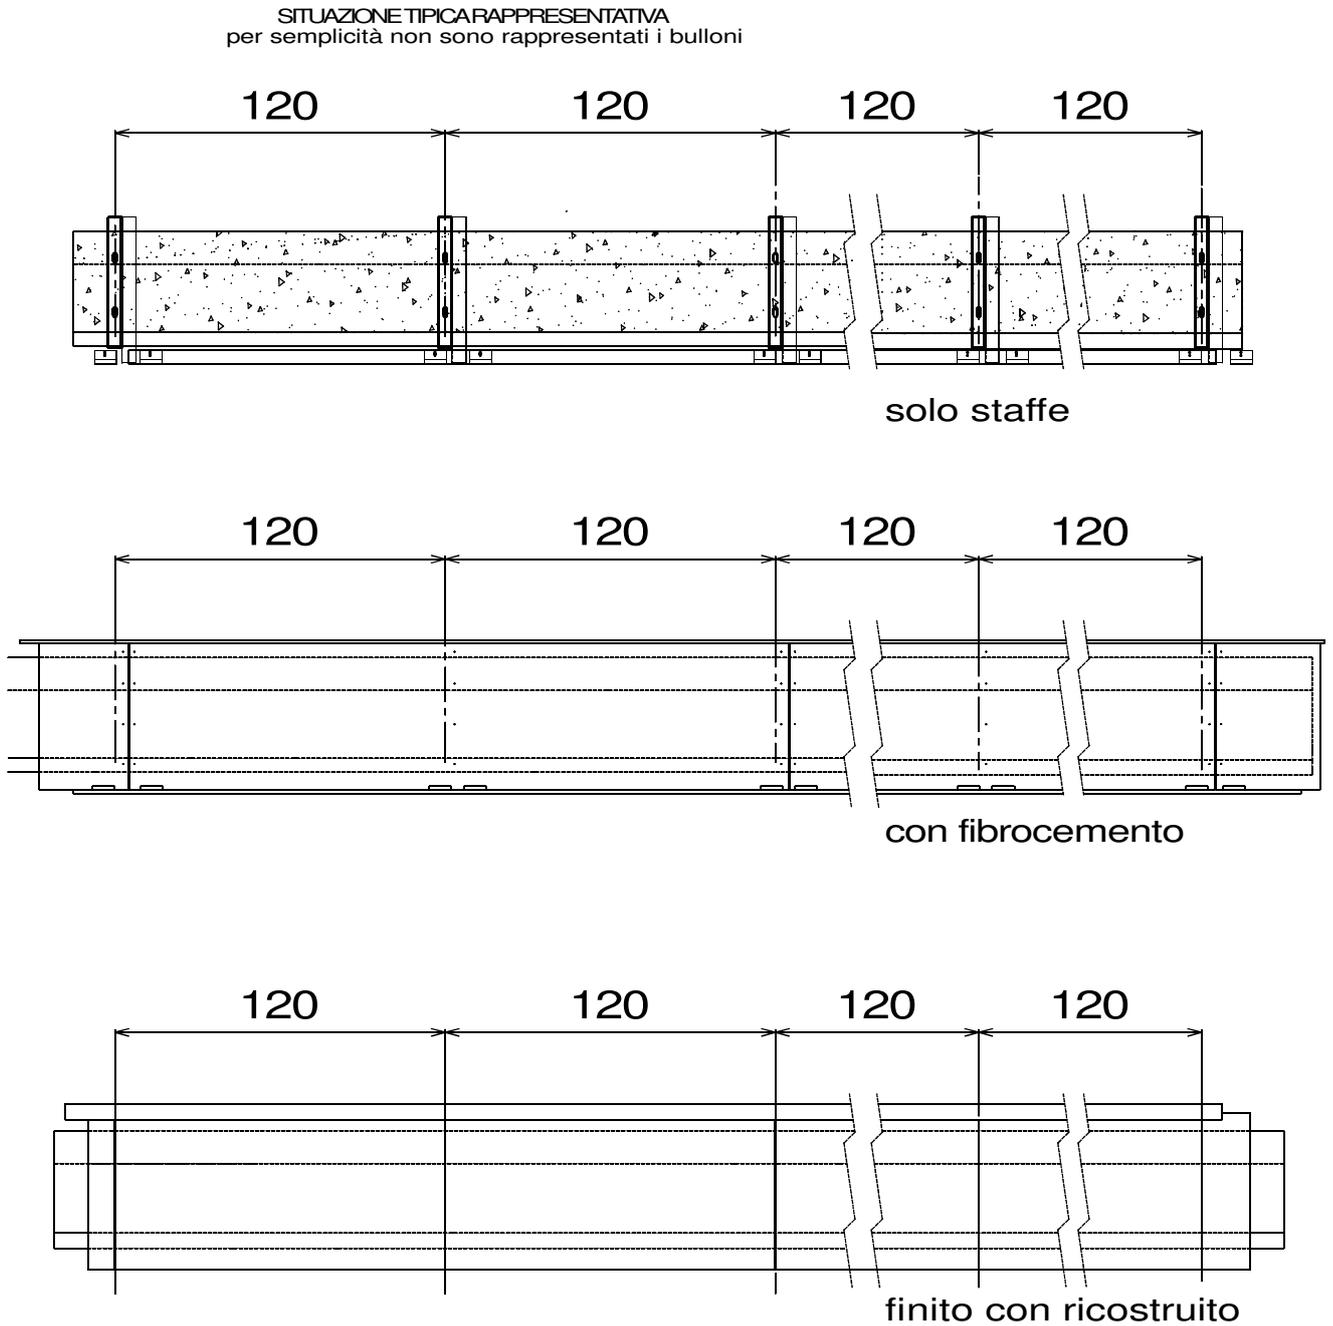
VISTA FRONTALE MANUFATTO CON LA SEQUENZA DI MONTAGGIO
